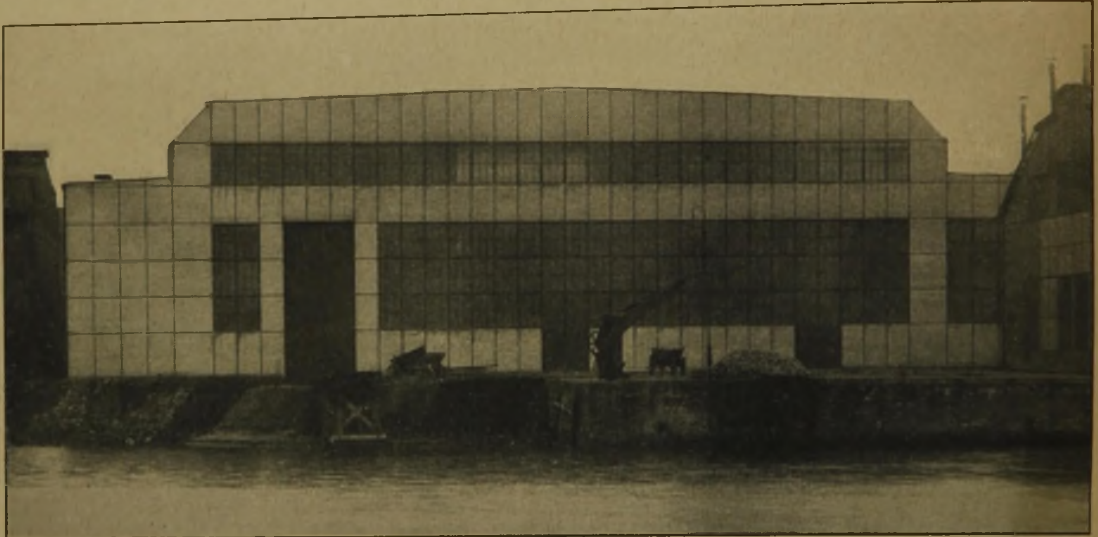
Neue Eisenfachwerk- und Glas-Fassade der Montagehalle.
